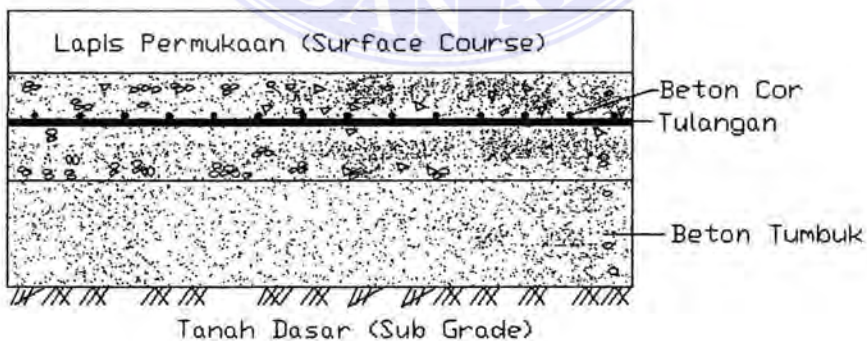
Lapisan Konstruksi Perkerasan jalan
